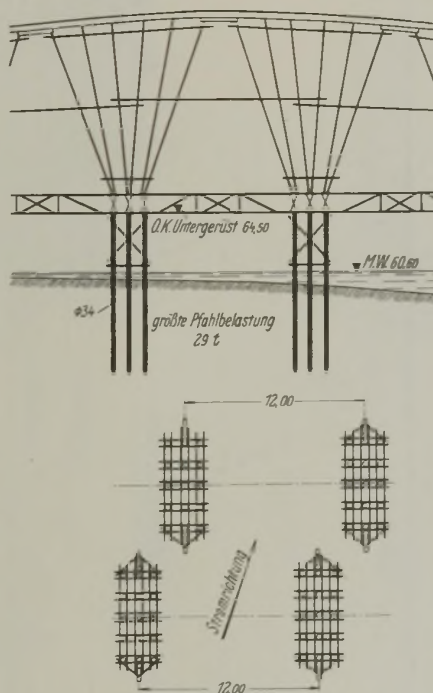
Grundriß-Skizze des Lehrgerüsts bei umsetzbaren Obergerüsten.
